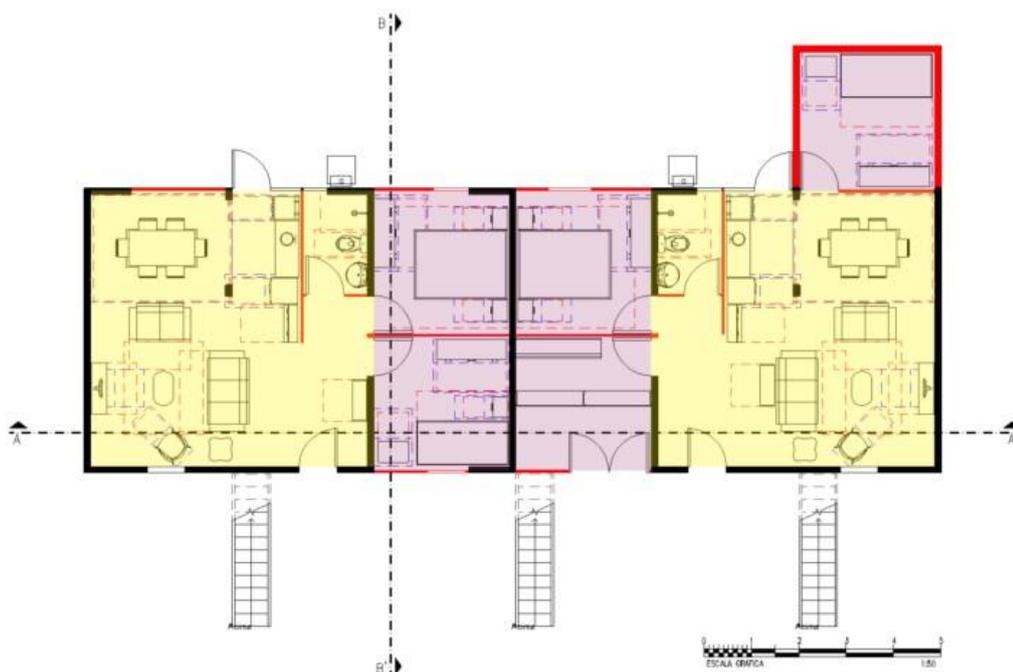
Quinta Monroy – Planta baixa pavimento térreo – Amarelo: módulos entregues prontos; Roxo: módulos para expansão; Paredes em preto: fixas; Paredes vermelhas: divisórias de fácil remoção. (fonte: ALBANO, LONGSDON, FABRICIO, 2019, p.1345 – imagem elaborada pelos autores)
